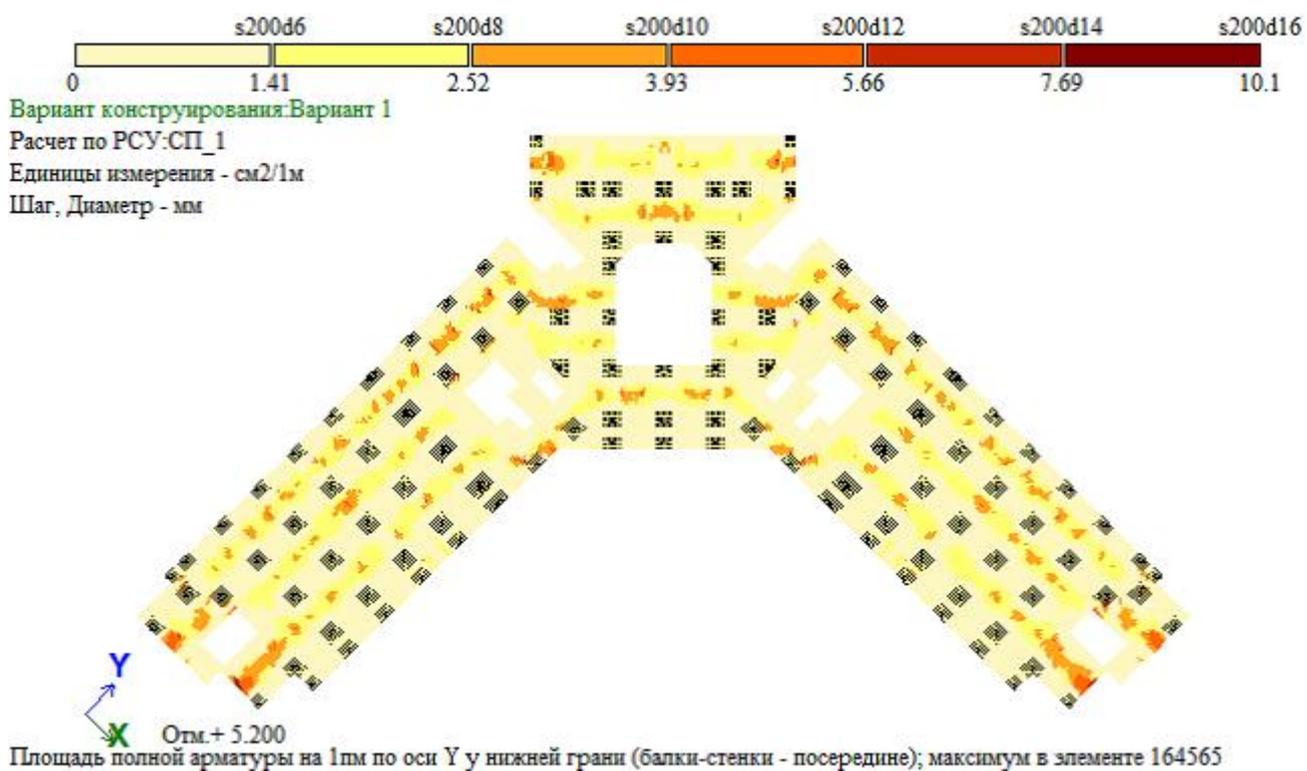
Армирование плиты на отм. +5.400. AS3 (нижняя по Y1)
